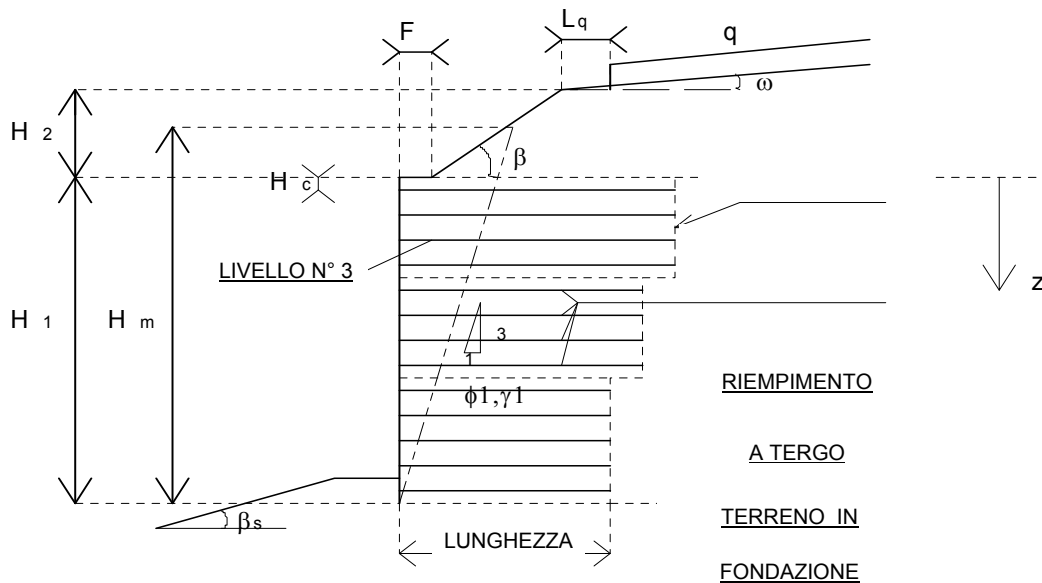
Sezione trasversale di un muro in terra armata (ad esempio sez. trapezoidale)
